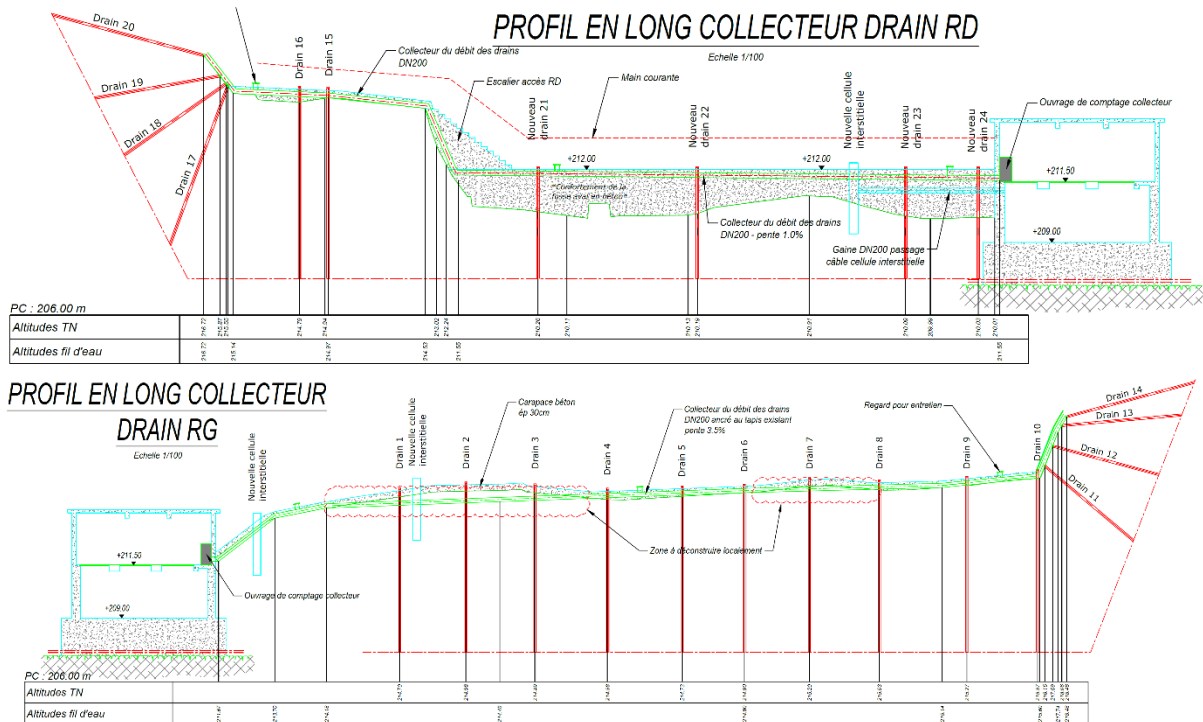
Coupe sur drains complémentaires et nouveaux collecteurs en rive droite et gauche [Réf 4]
